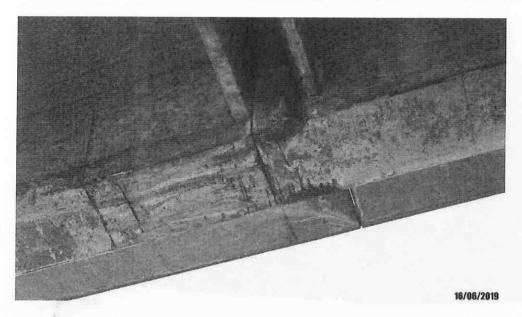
Detalhe da face inferior da viga com armadura exposta e infiltração na junta de dilatação.
